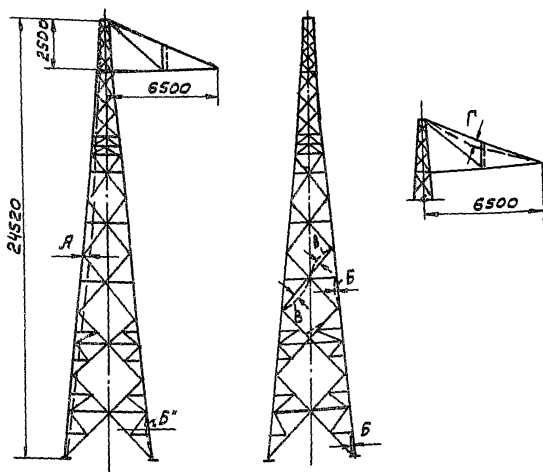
Допуски на сборку стойки анкерно-
